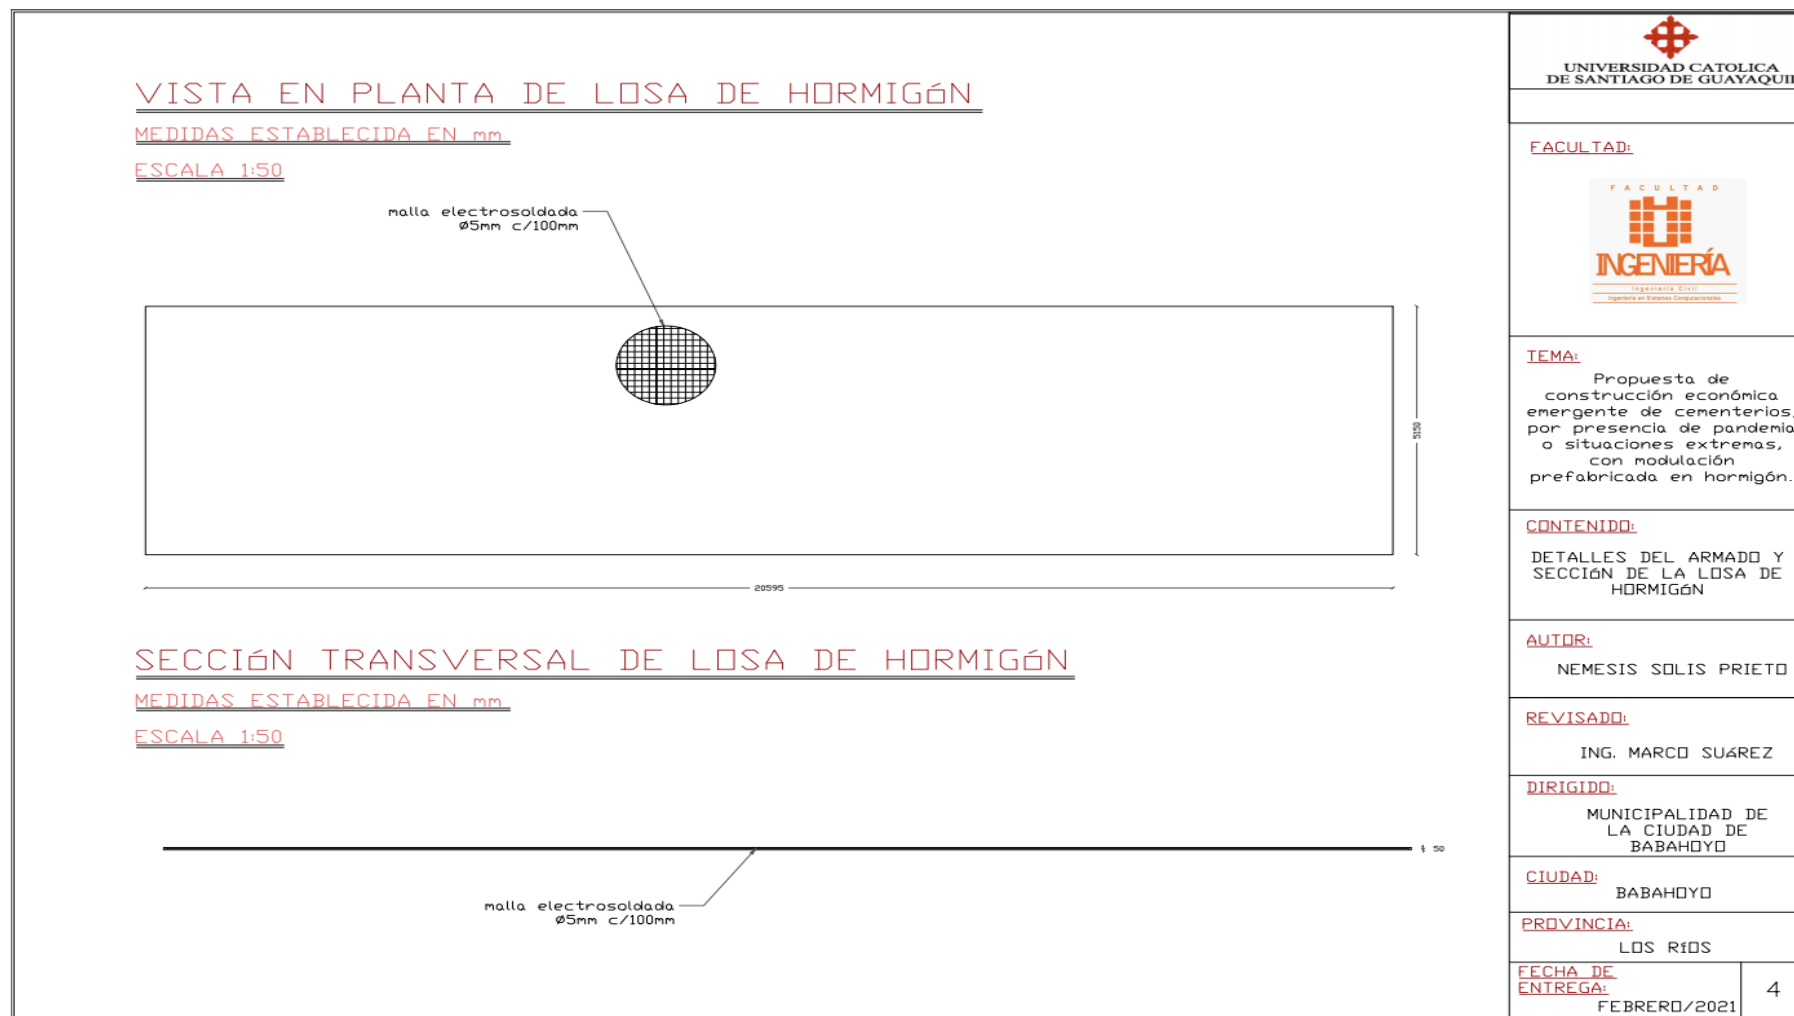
Planos de la vista en planta de la losa de hormigón
